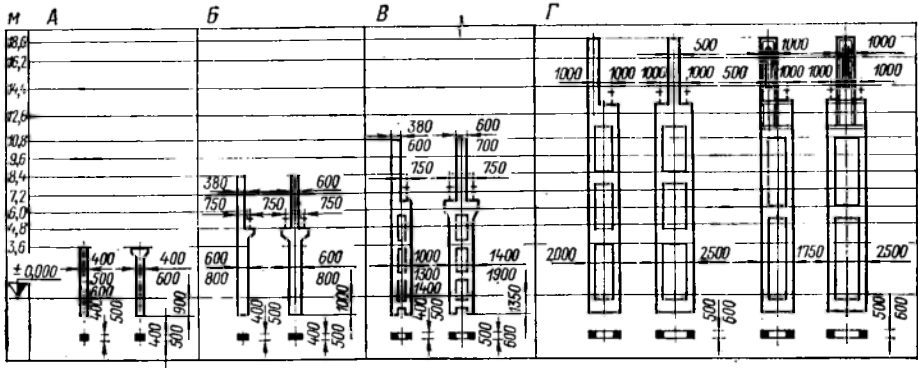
Типовые унифицированные сборные железобетонные колонны (кратно 1,2 м; свыше 10,6 м —кратно 1,8 м):
